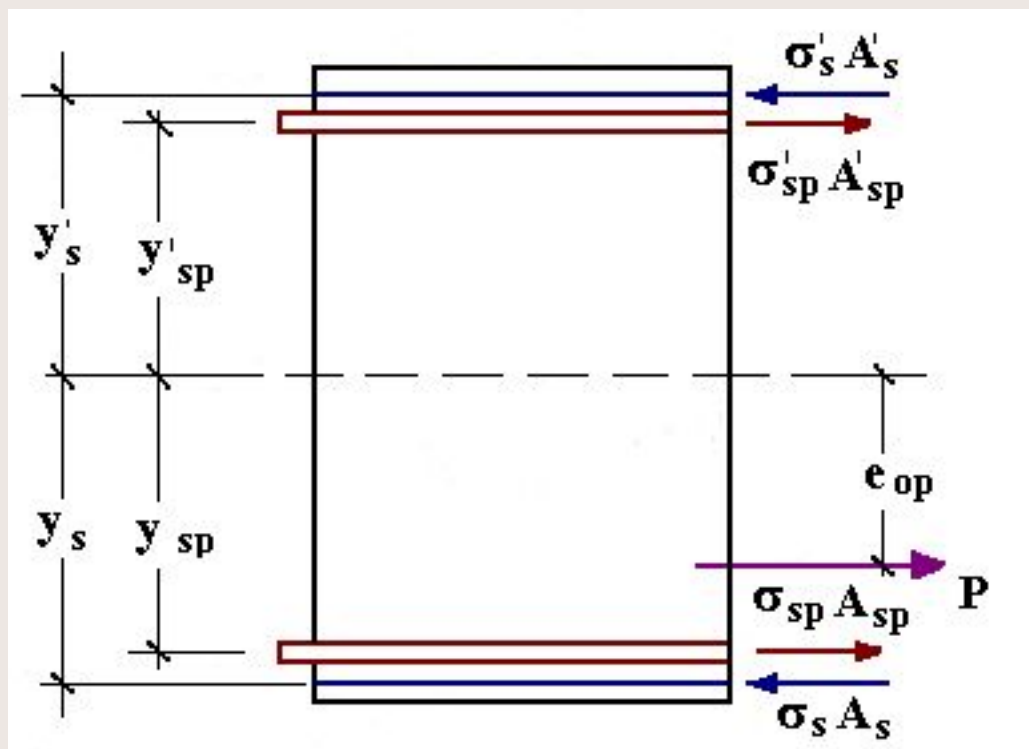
Схема усилий предварительного напряжения в арматуре в поперечном сечении железобетонного элемента
